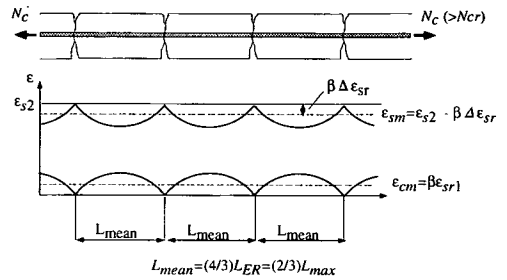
安定ひび割れ状態の鉄筋、およびコンクリートのひずみ
